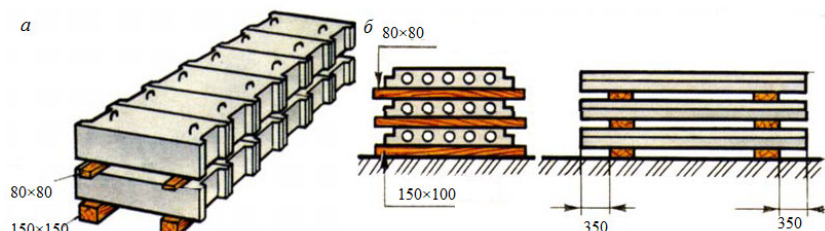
Схеми складування: *а* – фундаментних блоків; *б* – плит перекриття,
